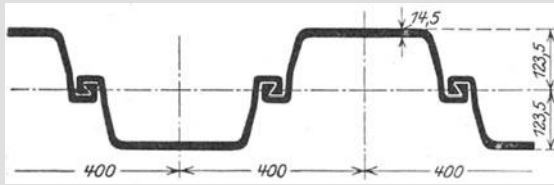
Neue Bauart Larsen mit gewalztem Schloß. Maßstab 1:16.
